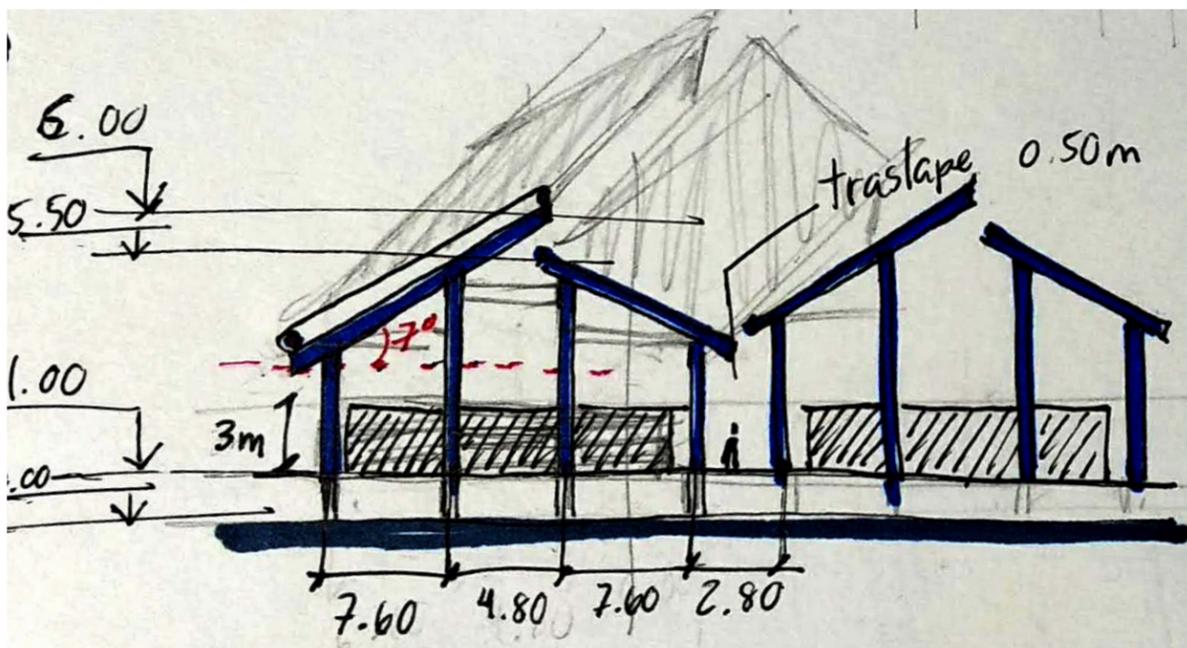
Croquis de estructura de cubierta. Elaboración propia.
